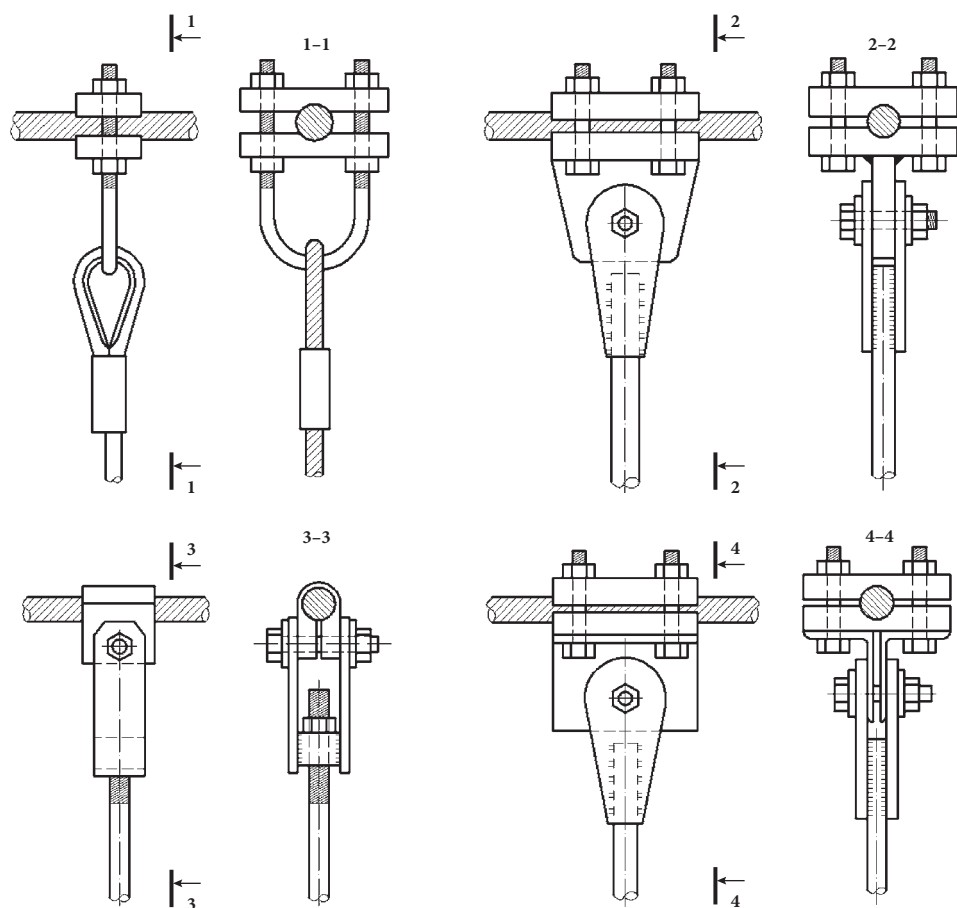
Варианты крепления растяжек к поясам вантовых ферм
